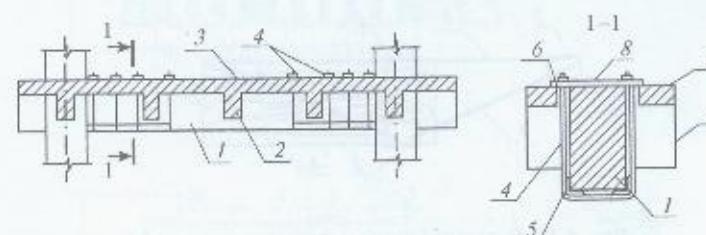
Усиление главных балок монолитного железобетонного перекрытия установкой стяжных хомутов на опоре:
